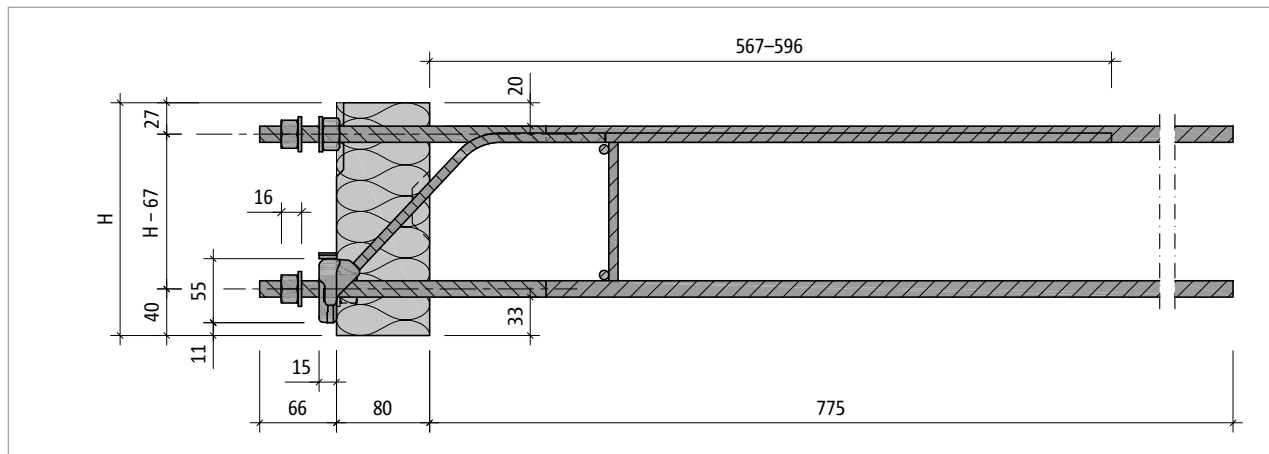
Schöck Isokorb® T type SK-MM1-VV1 : coupe du produit
